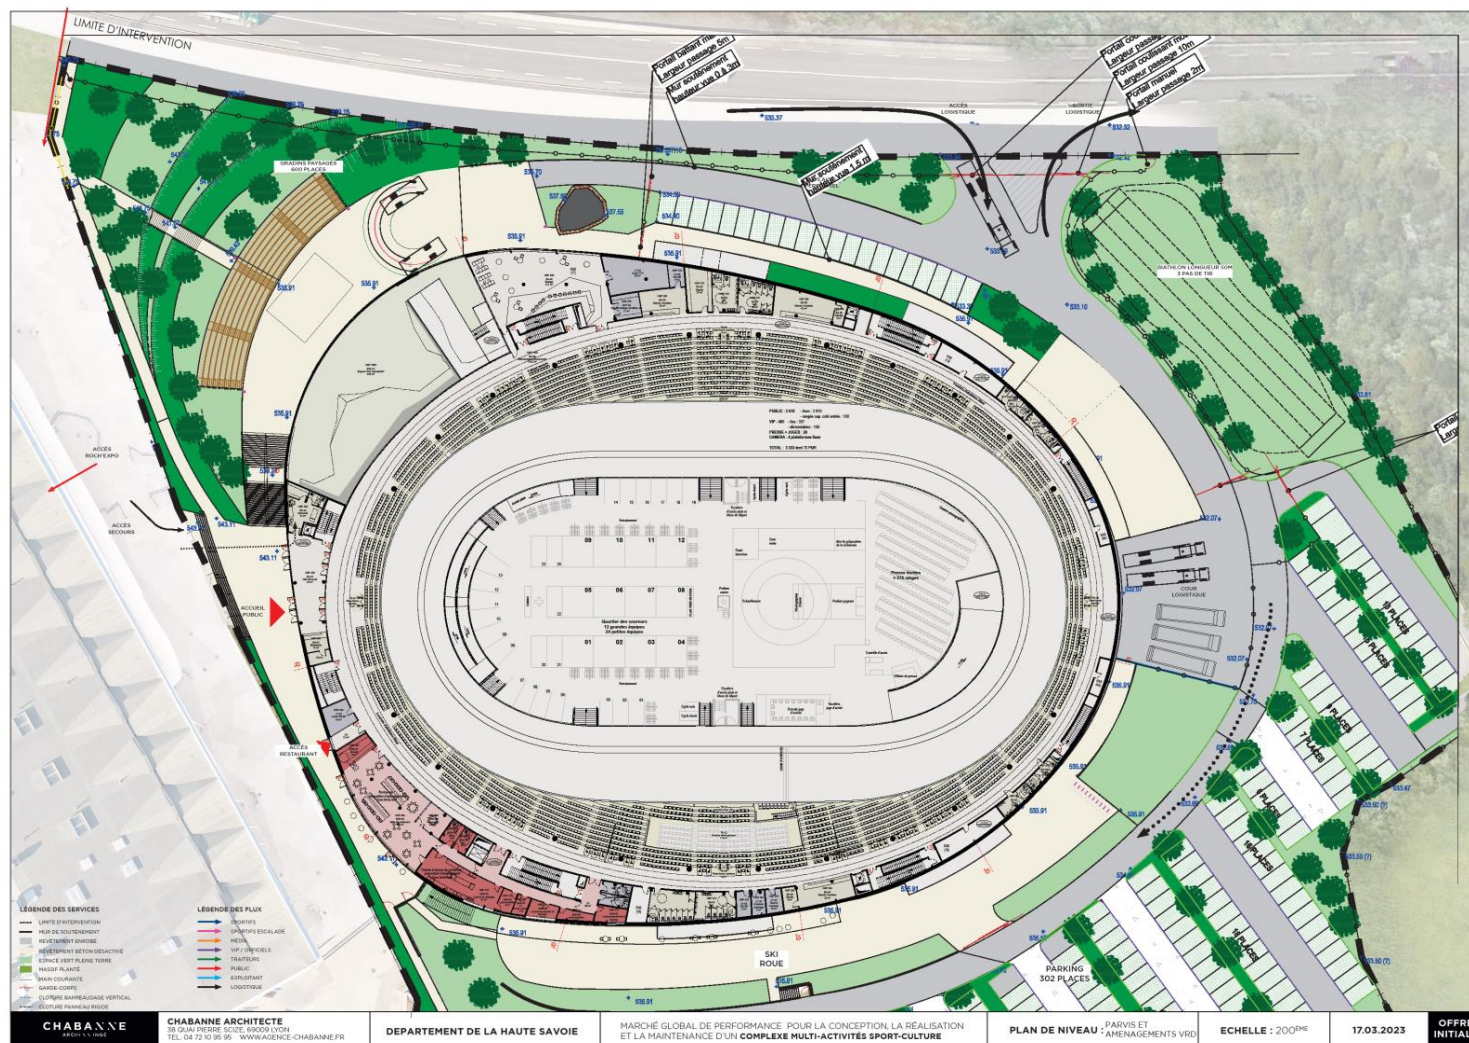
Plan VRD (Source : Chabanne Architecte)
